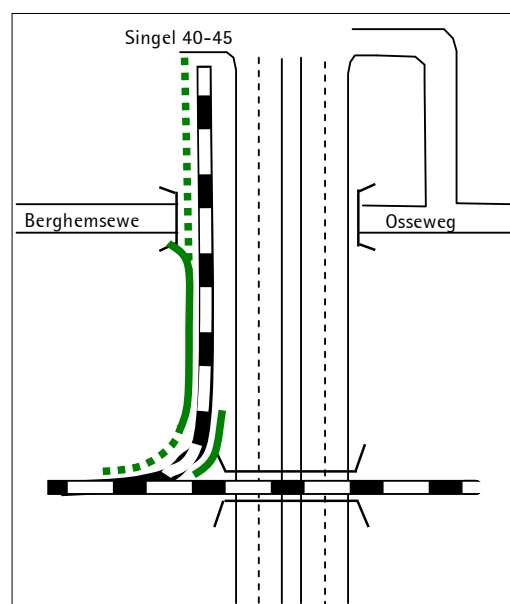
Planalternatief 1 bewoners Schadewijk
